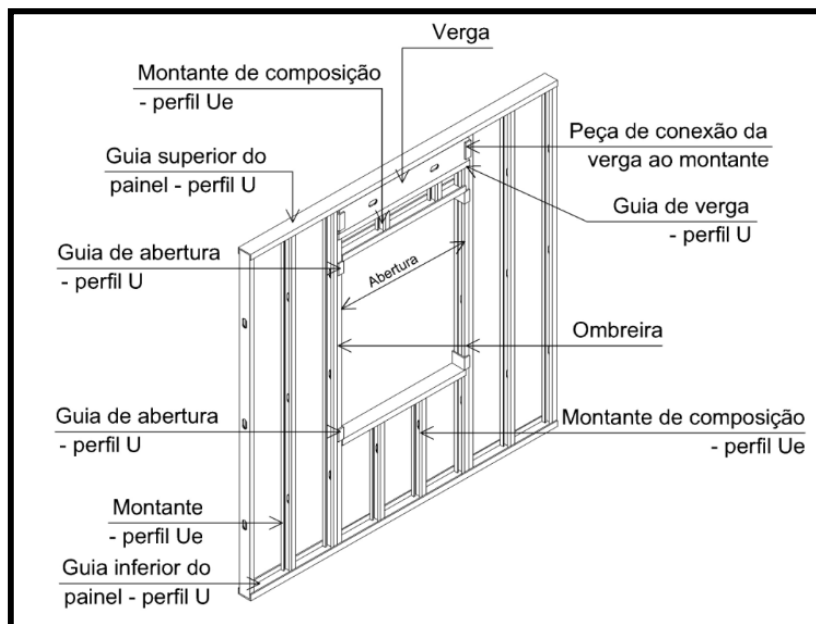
Desenho esquemático de uma parede estrutural com abertura [20]
